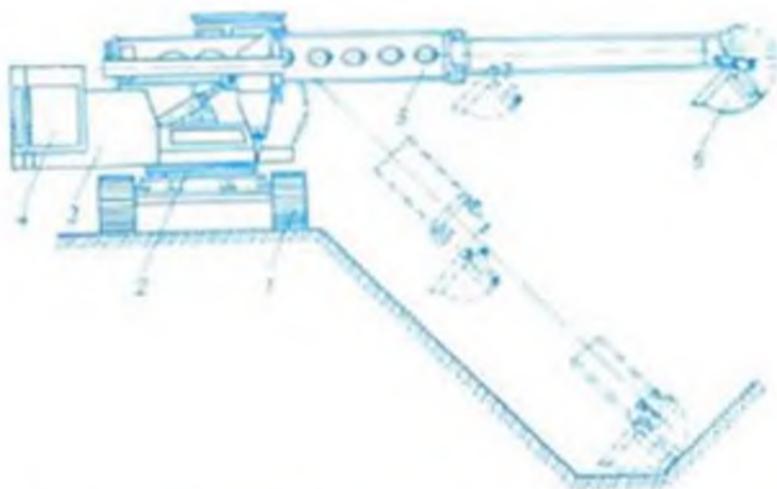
Одноковшовый экскаватор ЭО-2131А: 1 — гусеничный ход; 2 — опорно-поворотное устройство; 3 — поворотная платформа; 4 — силовая установка; 5 — телескопическая стрела; 6 — ковш.
